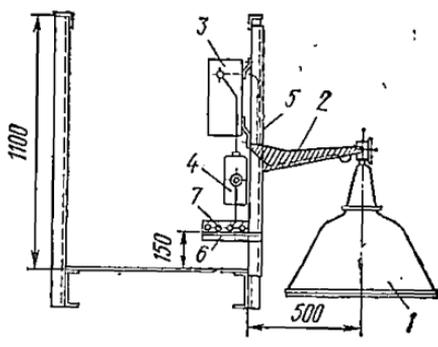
Установка кронштейна КРП-м со светильником для лампы ДРЛ на ограждении мостика:
